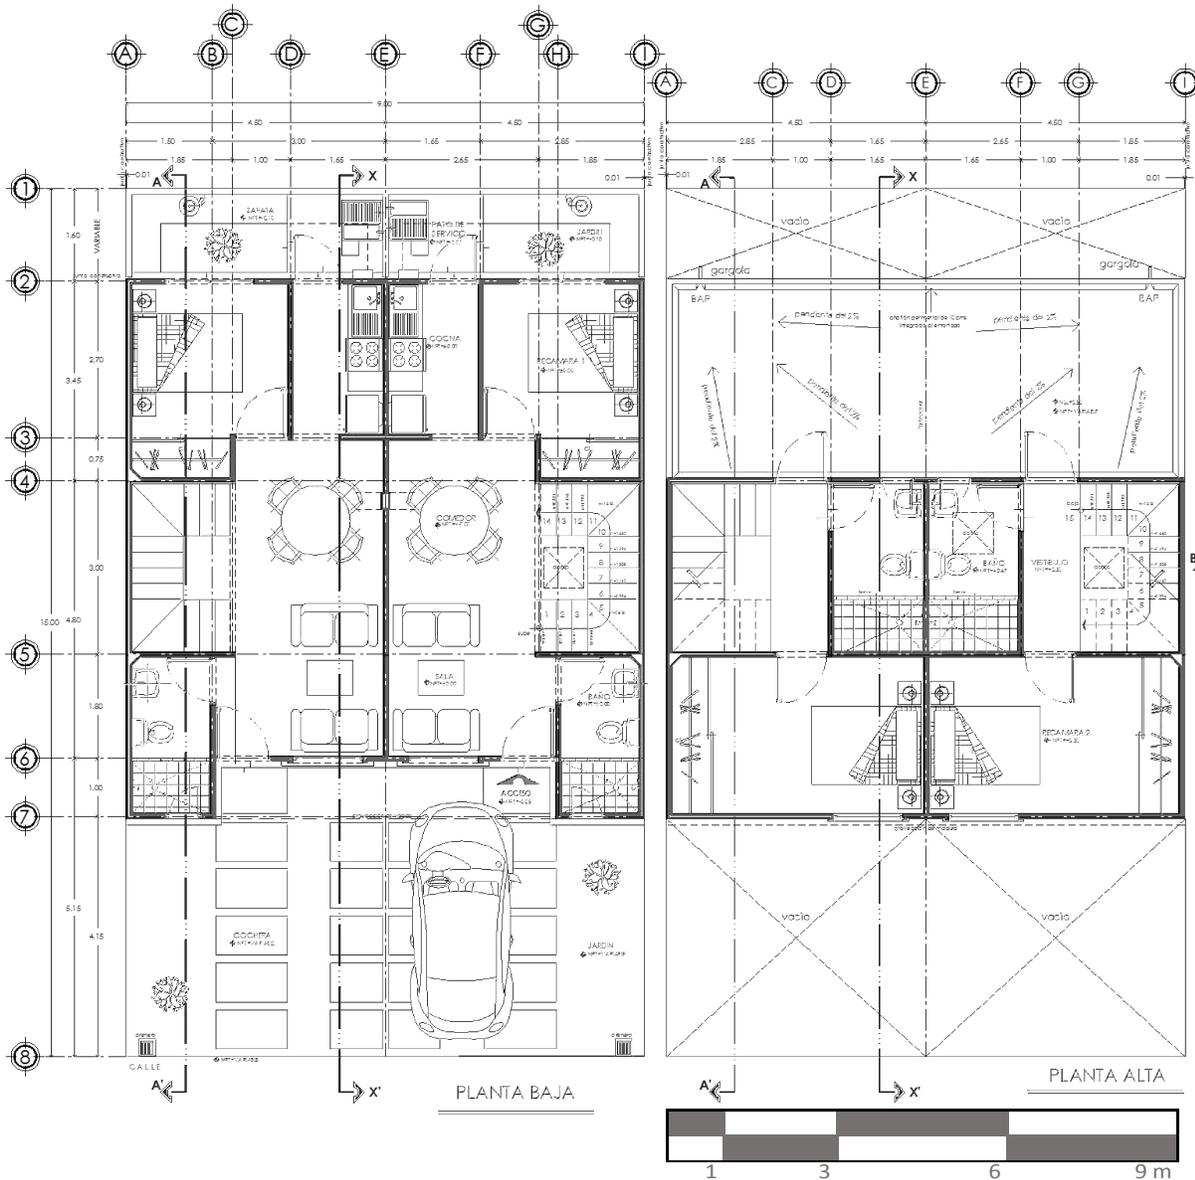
Plantas Arquitectónicas del Prototipo Fuego 2N-2R
